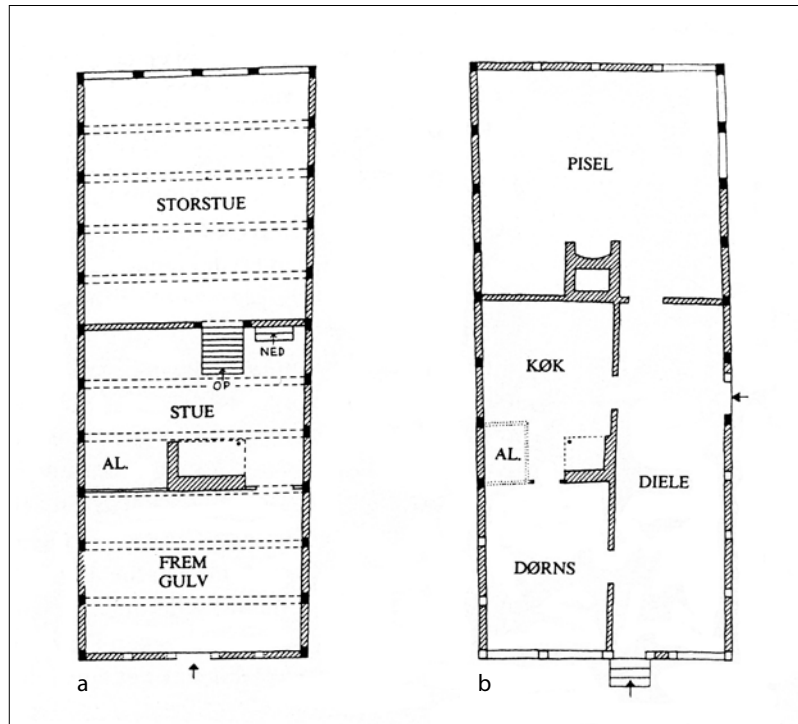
a: Mittelalterlicher, linearer Grundriss, Grønnegade 12, Ribe 1533; b: Neuzeitlicher Stubengrundriss mit Dielenaufschluss, Slots-gade 23, Haderslev 1568.
